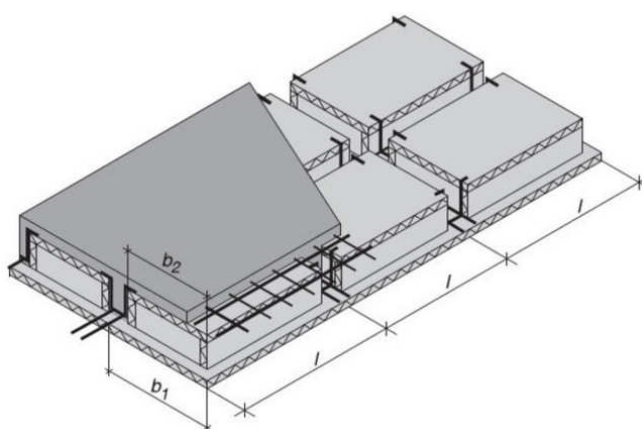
U-Bahn Beton – rozmístění tvarovek zdroj [15]
